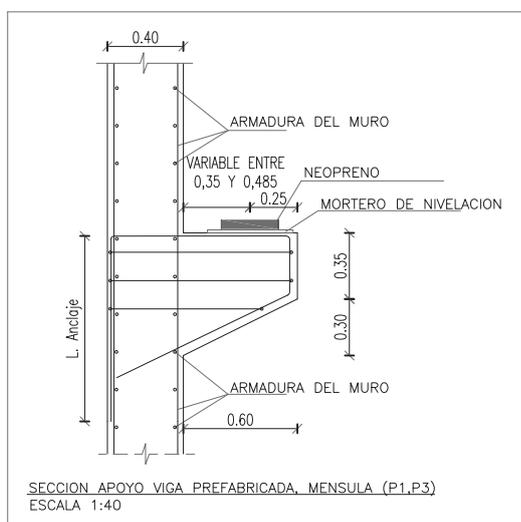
Detalle en sección del apoyo de la viga. Escala 1:40 [27] IMAGEN 3.16 Detalle en sección del armado de la viga. Escala 1:40 [27]
